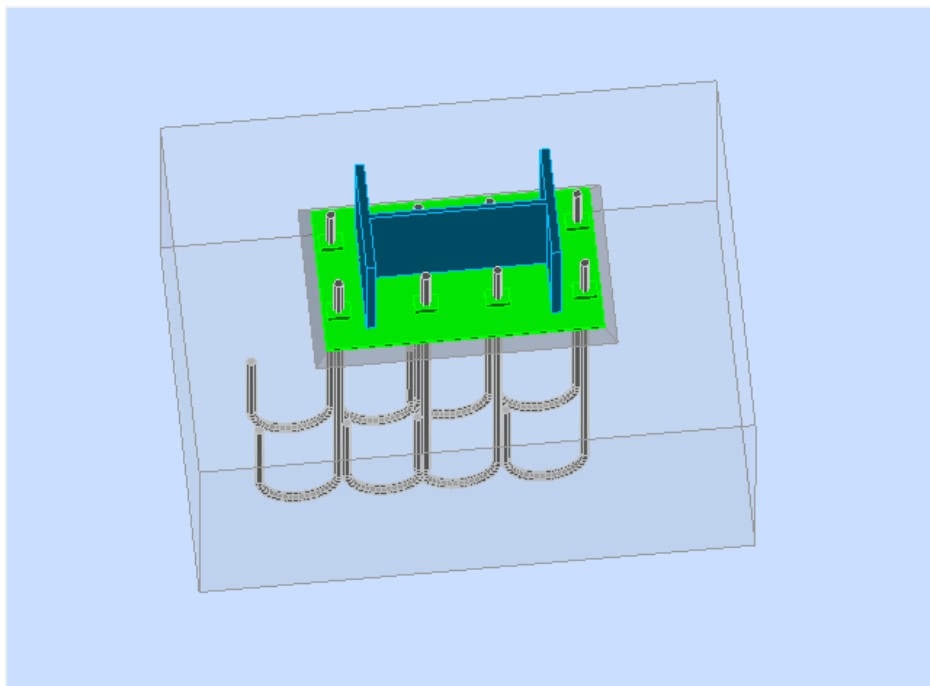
Vue en 3D de la jonction poteau-fondation
